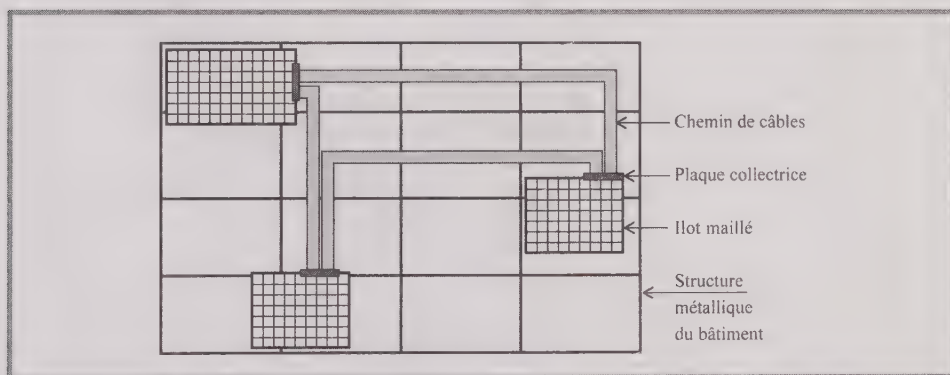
Exemple de plan d'un bâtiment maillé par îlots.
